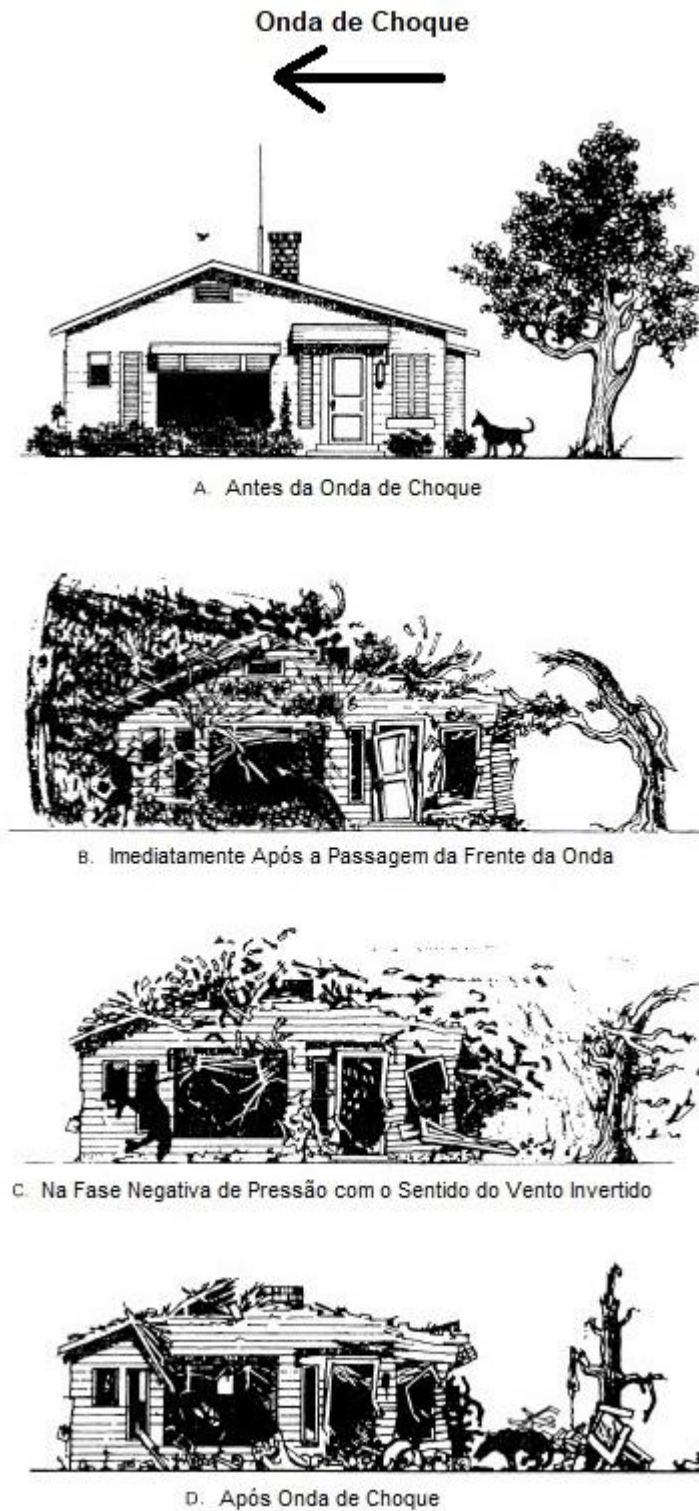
Fases de impacto explosivo, adaptado de [21].
